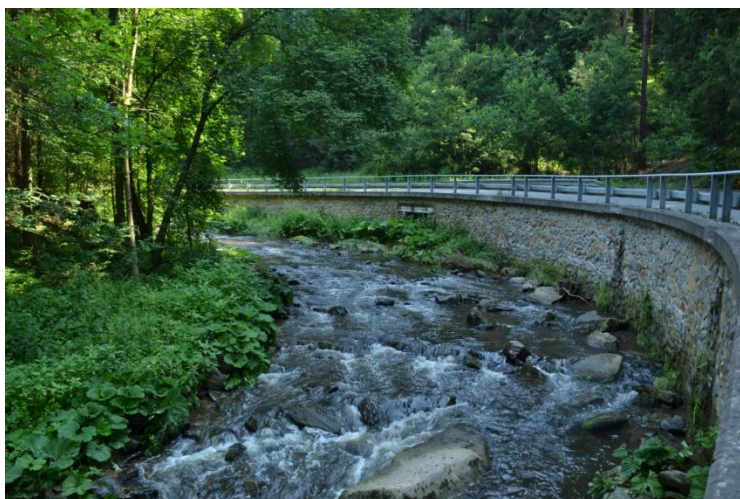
Stabilizační stupeň vybudovaný nad městem Štíty (pořízeno 21.3.2013)
